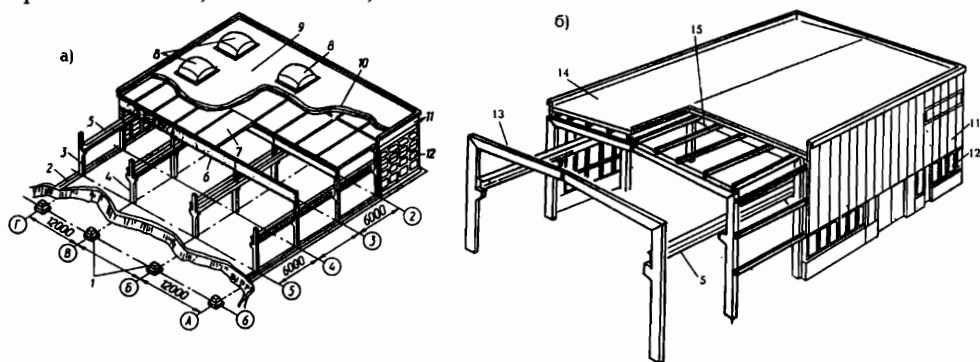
Производственные одноэтажные здания: а - со стропильными балками в покрытии; б - с несущими рамами; 1 - фундаменты; 2 - фундаментные балки; 3, 4 - колонны крайнего и среднего рядов; 5 - подкрановые балки; 6 - балки покрытия; 7 - плиты покрытия; 8 - зенитные фонари; 9 - воронка водостока; 10 - рулонное покрытие кровли; 11 - панели стен; 12 - оконные переплеты; 13 - рама; 14 - кровля по профилированному настилу; 15 - прогон
